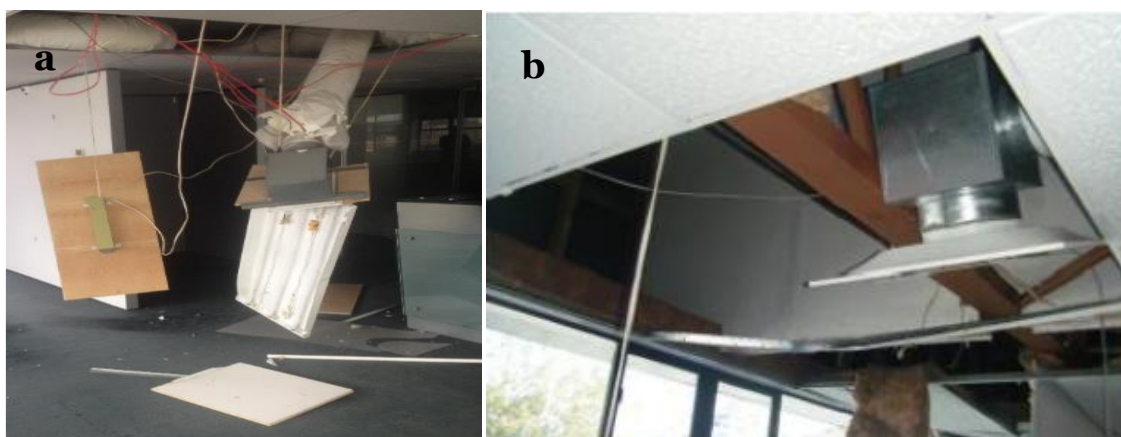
Fissuração do teto de painéis de gesso cartonado (a) e colapso total do sistema e queda das vigas metálicas (b) [[36]
